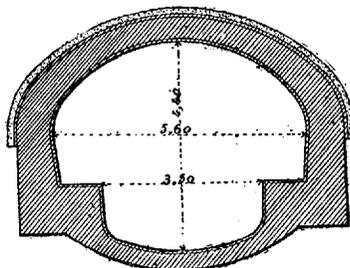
Coupe d'un égout avec cunette et double banquette latérale.
